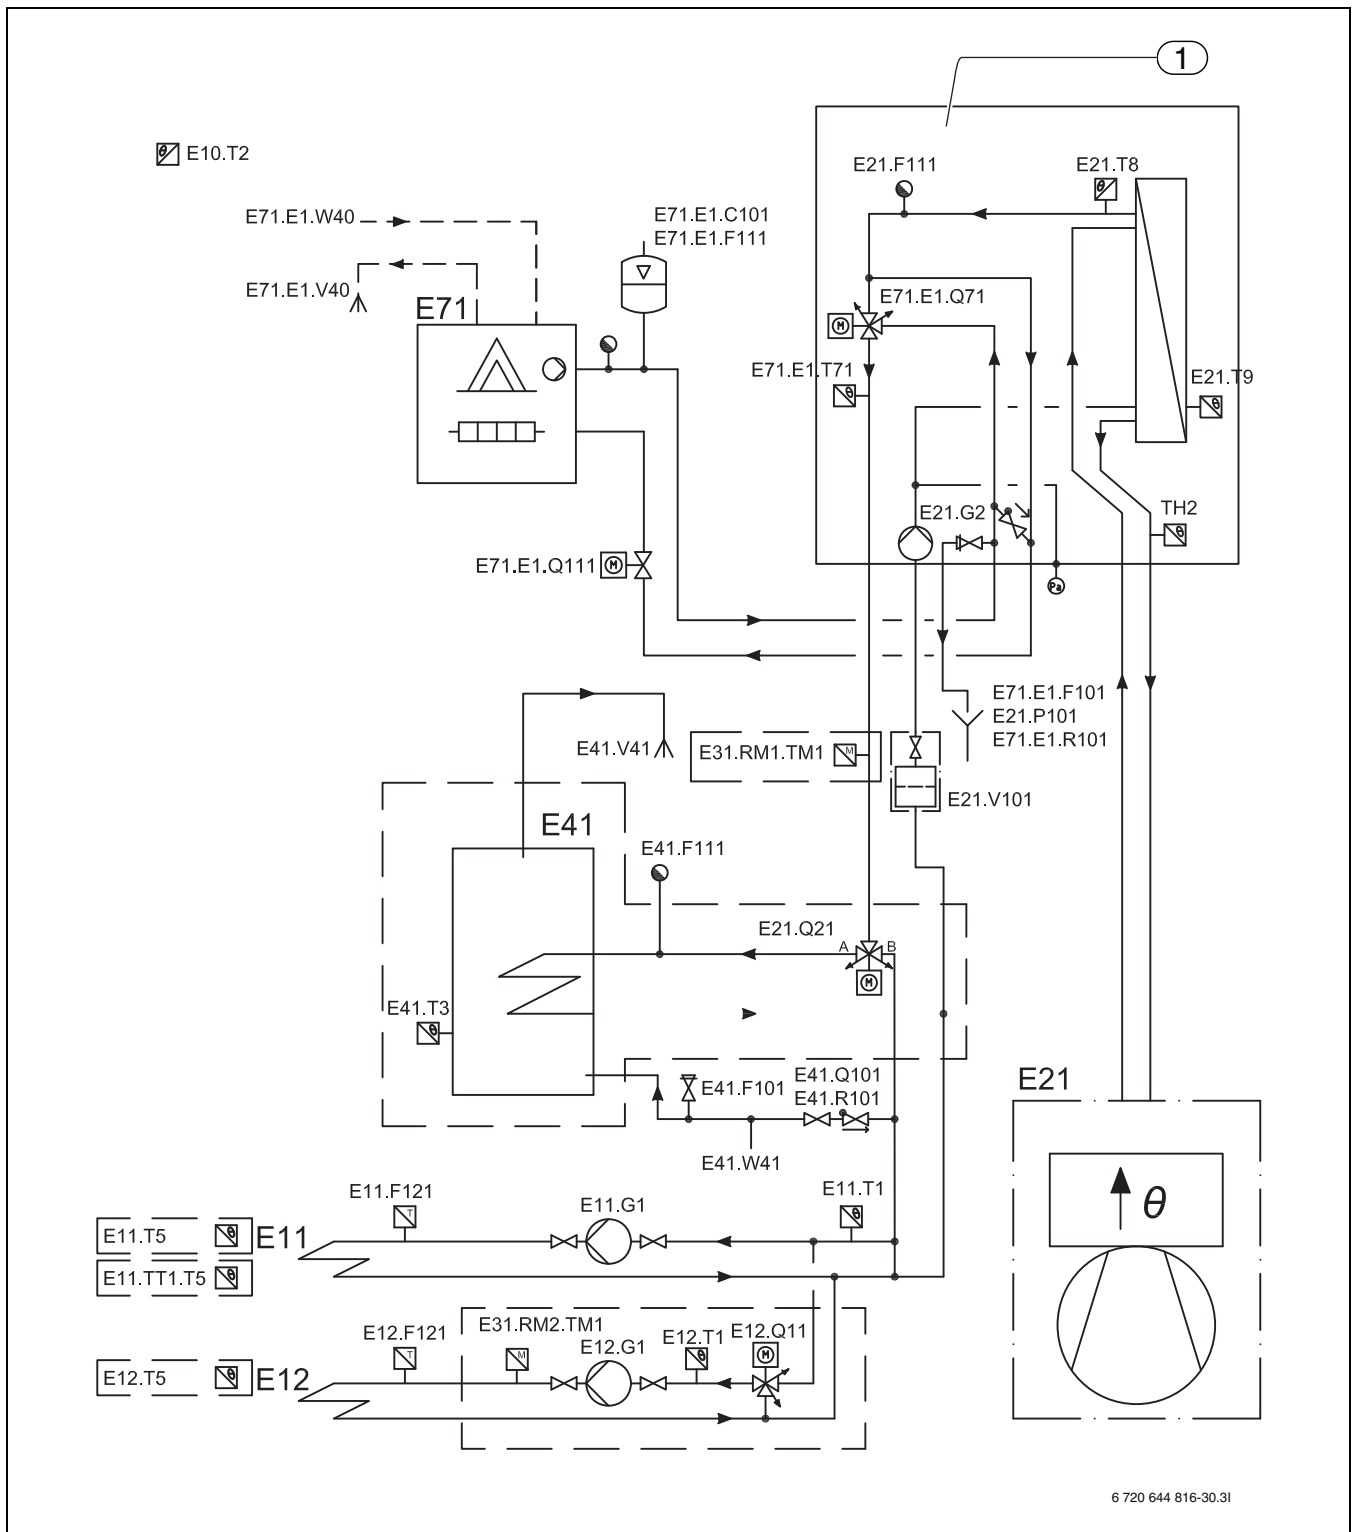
Дополнительный нагреватель со смесителем с баком-водонагревателем
